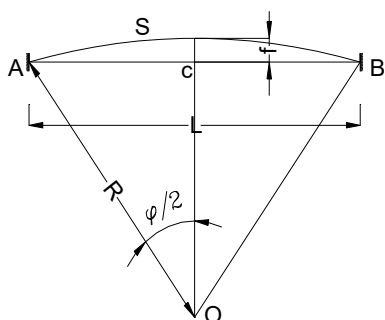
Расположение образующей между колоннами перекрытия А и В
